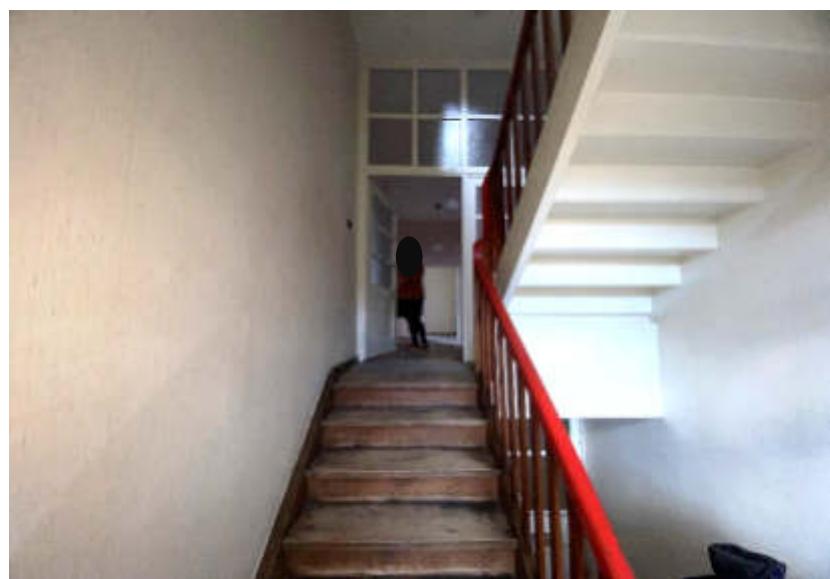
des SV: Treppenhaus, Zugang Wohnung OG; Anonym.d.d. SV
